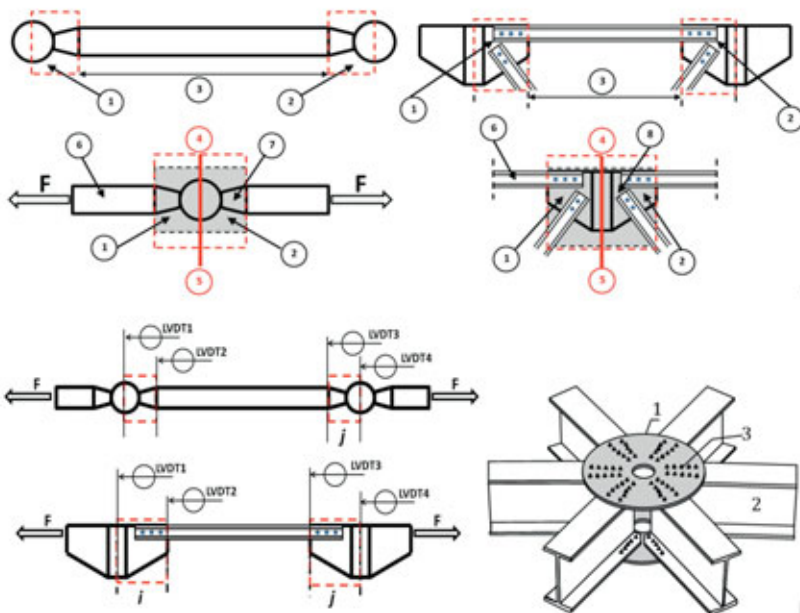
Dettagli delle strutture reticolari spaziali di copertura trattate nell'Allegato T della EN 1999-1-1: a) definizione di collegamento e unione; b) prova sperimentale su un campione completo relativo ad un'asta ed ai suoi collegamenti di estremità.
